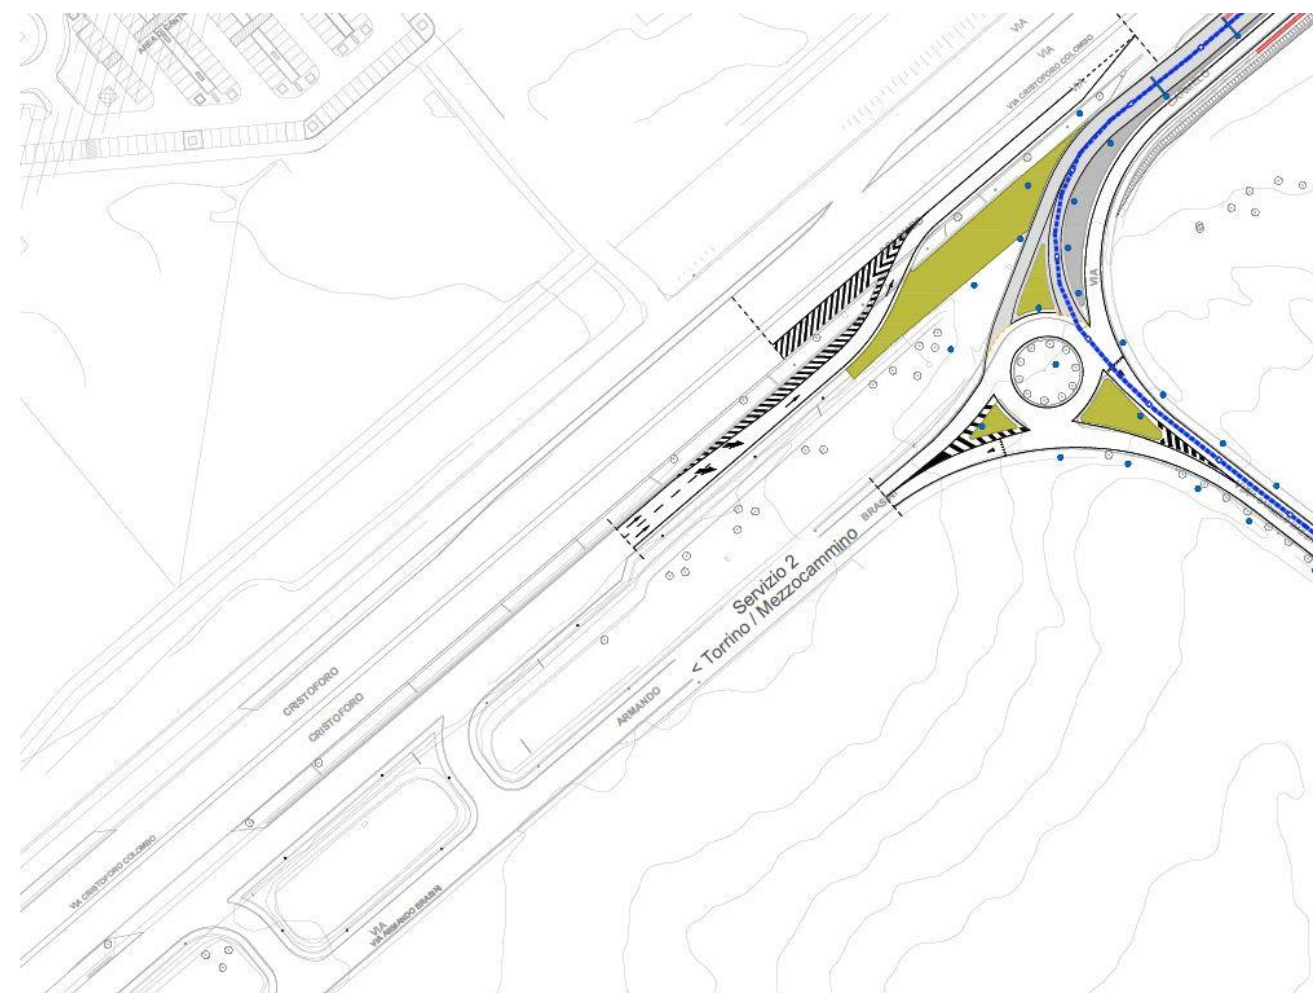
sistemazione planimetrica dell'intersezione presentata in CdS
